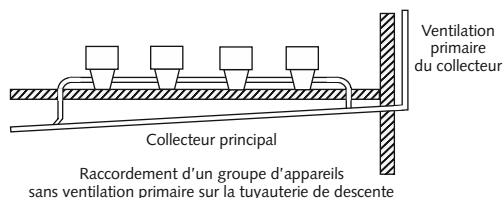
Raccordement d'un groupe d'appareils sans ventilation primaire sur la tuyauterie de descente
